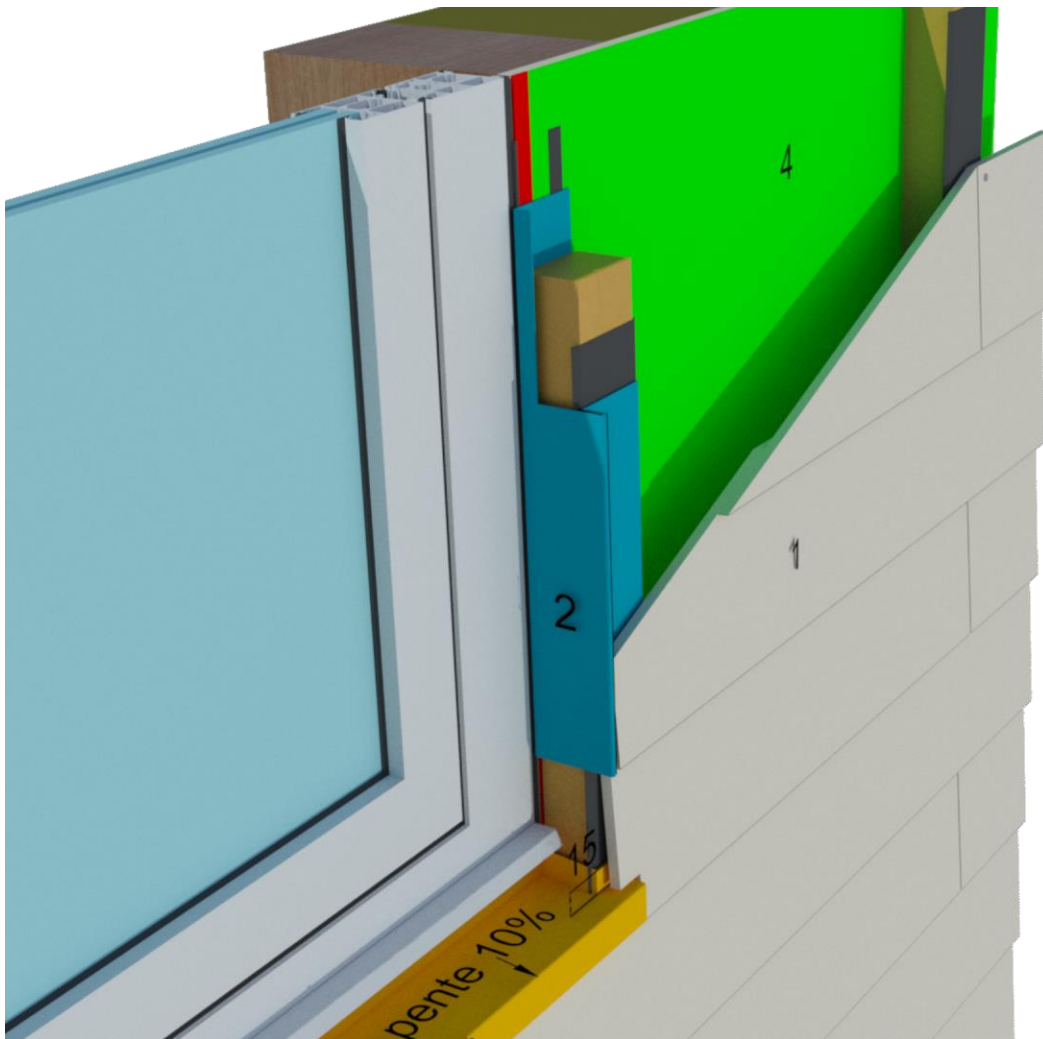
Pose sur COB – Coupe sur tableau de baie
